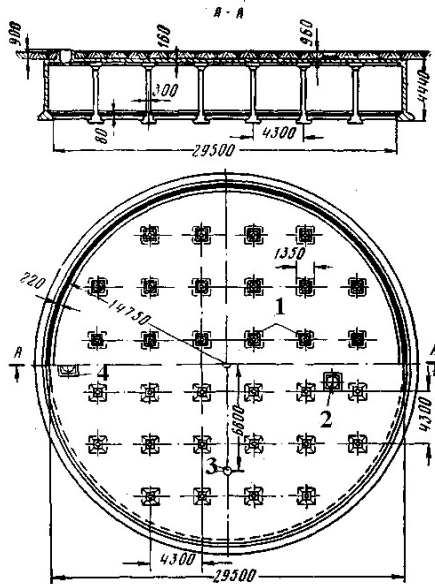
Циліндричний залізобетонний резервуар: 1 – колони; 2 – оглядовий люк; 3 – отвори для витяжної труби; 4 – зливний люк
